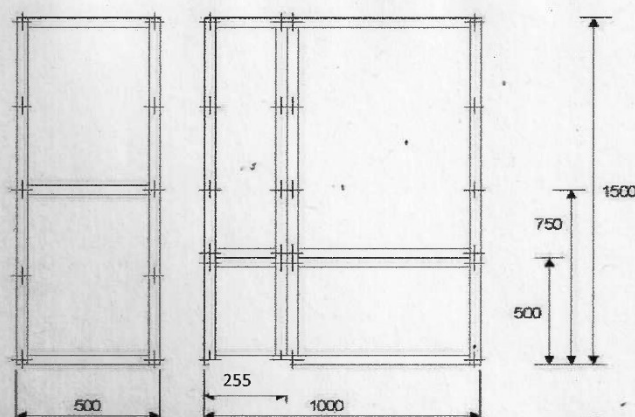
Esquema de las subestructuras usadas para ensamblajes de paneles de contrachapados en ala corta (figura de la izqd.) y ala larga (figura de la dcha.) Medidas en milímetros.
